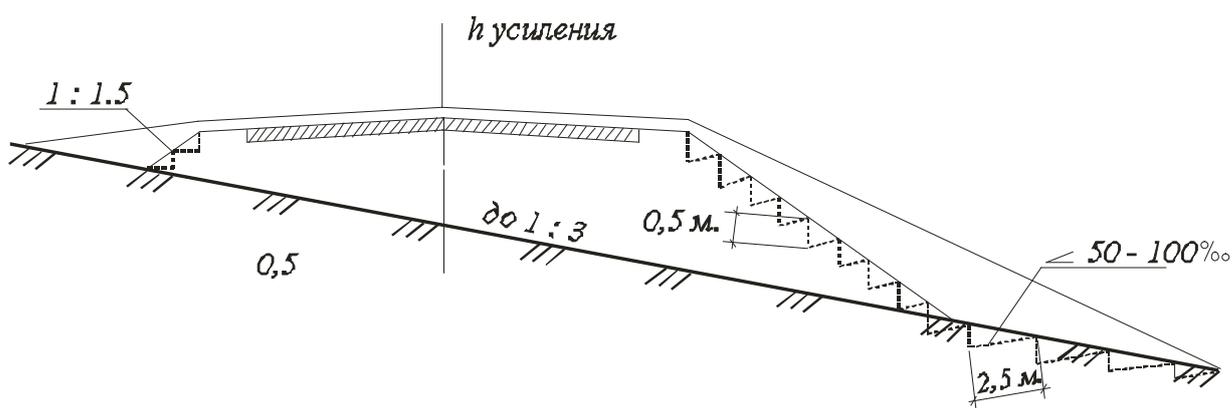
Вариант двустороннего уширения земляного полотна на косогоре
